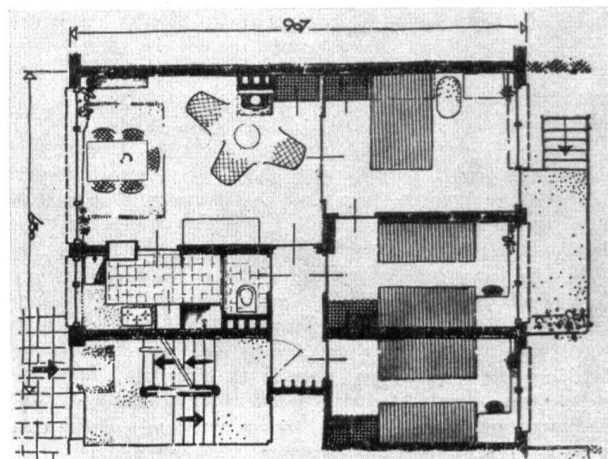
Grundrissstypus für Mehrfamilienhäuser.
